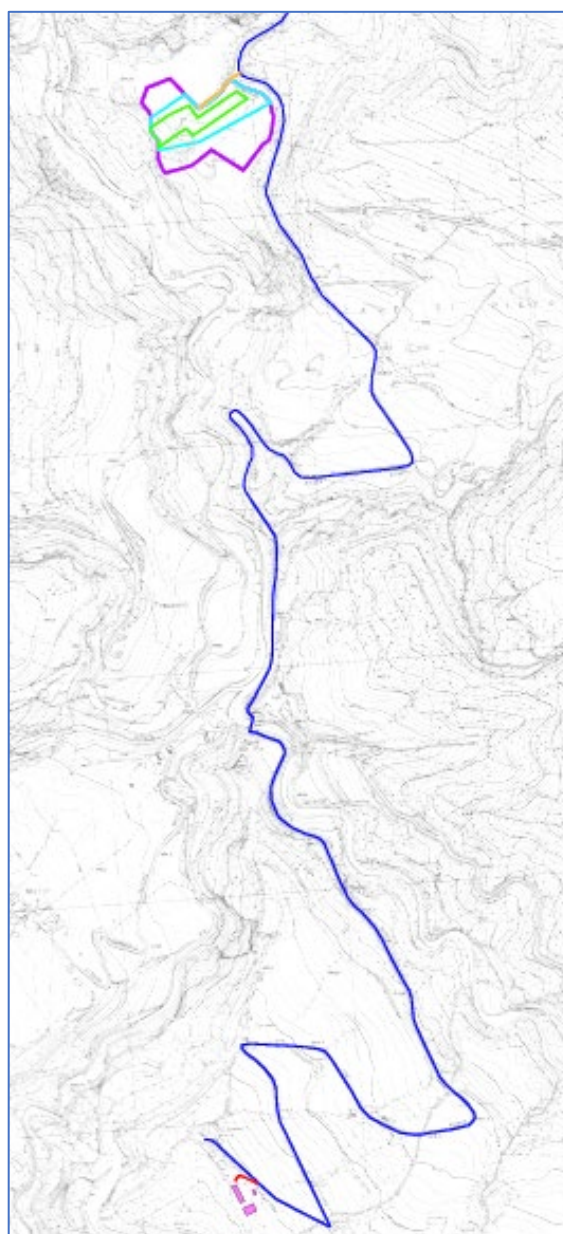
Viabilità di accesso della cava e di collegamento con il laboratorio – Tav2 di progetto
